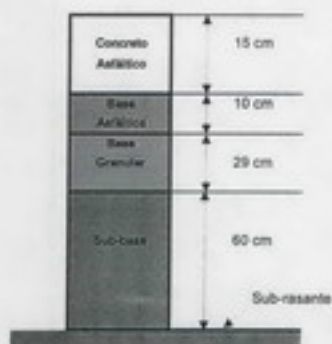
Alternativa 1 de construcción del pavimento nuevo
